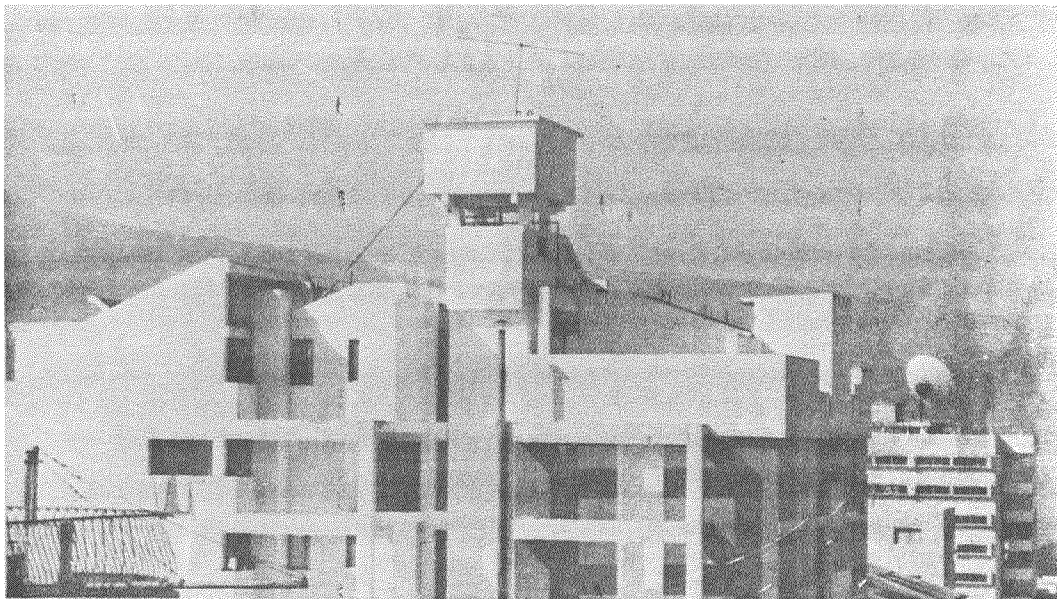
Existen edificaciones que presentan diversos problemas de diseño a nivel estructural que evidencian un nivel de vulnerabilidad alto como es el caso de este edificio de 7 pisos localizado en la Avenida 4 con planta baja libre, tanque elevado, porticos libres.
